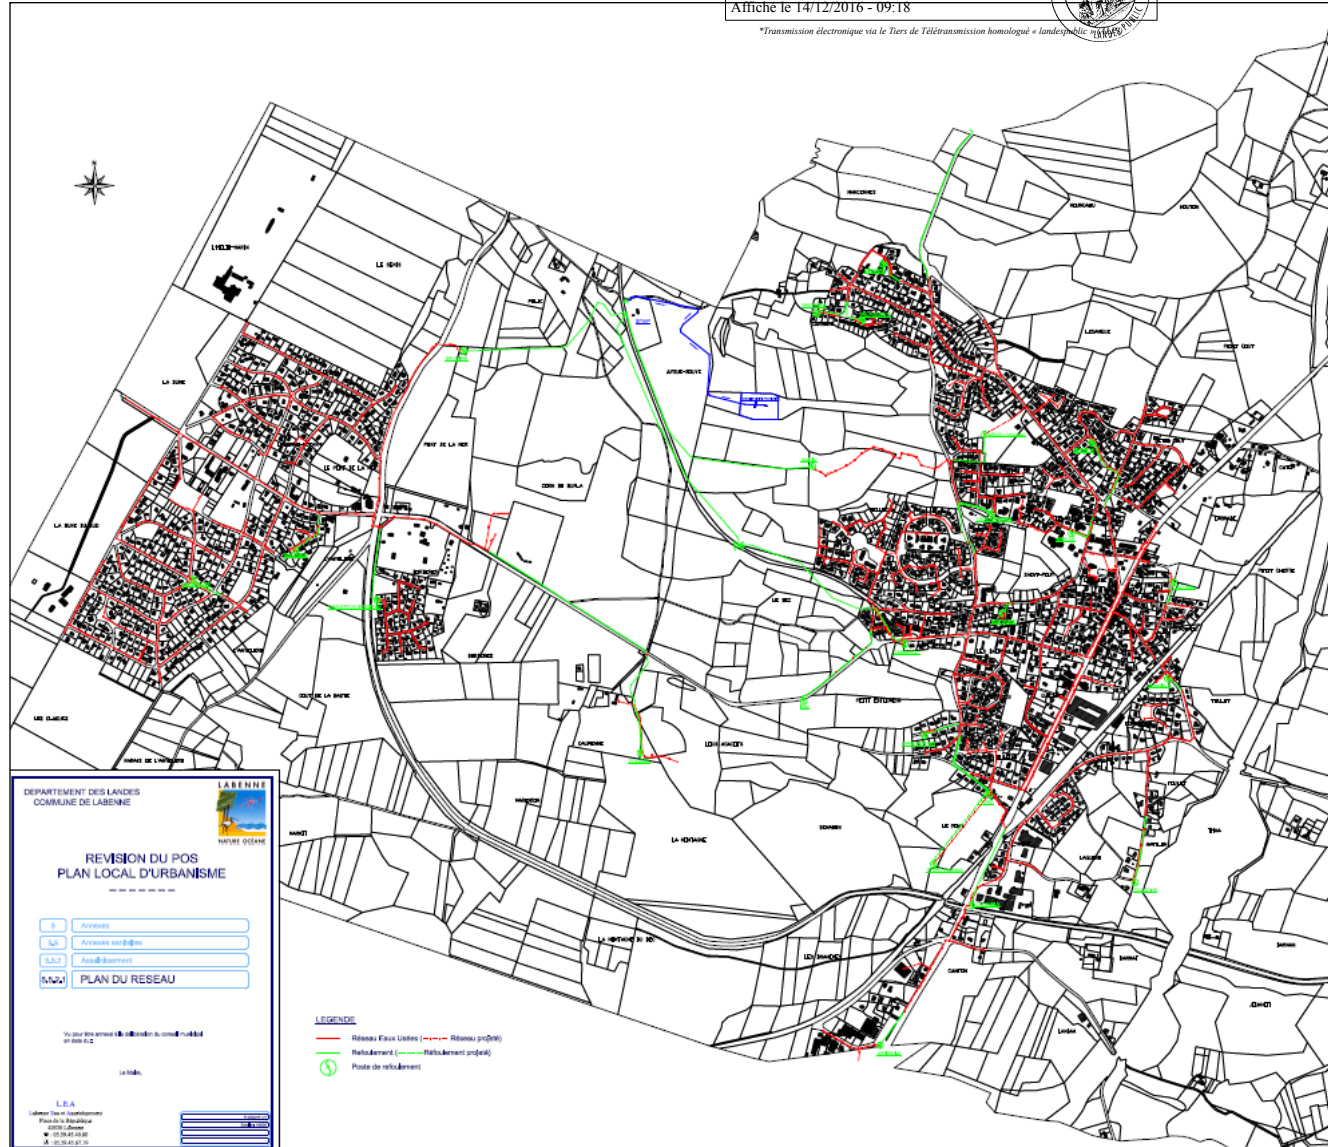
Plan général des réseaux d'assainissement en vigueur sur la commune de Labenne
